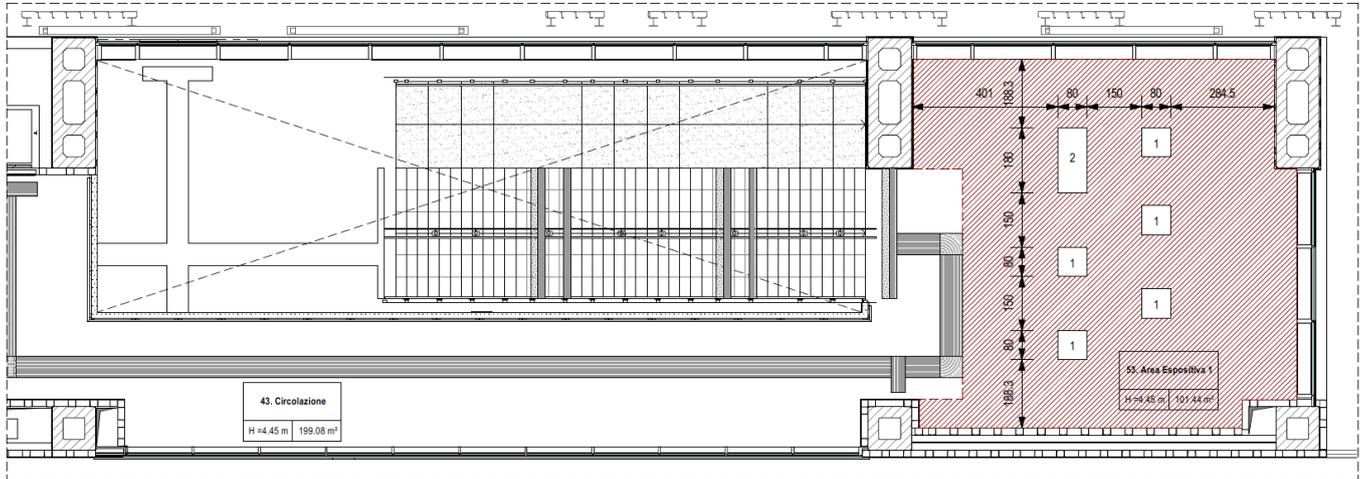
Pianta piano mezzanino con individuazione aree espositive
